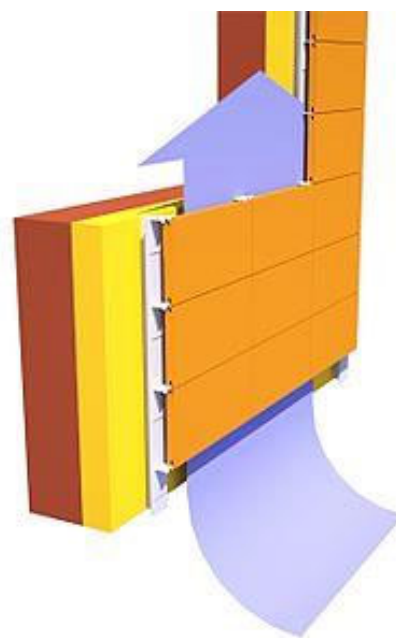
Внутреннее устройство вентилируемого фасада. Стрелка показывает направление циркуляции воздуха [3]
